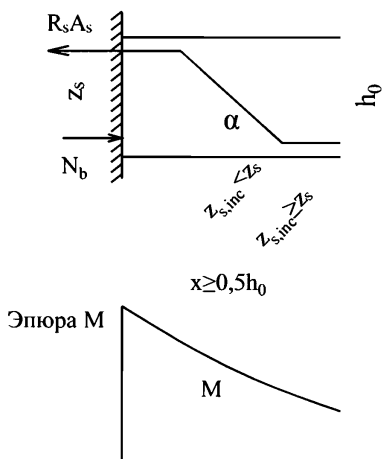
К определению места отгиба продольной растянутой арматуры
